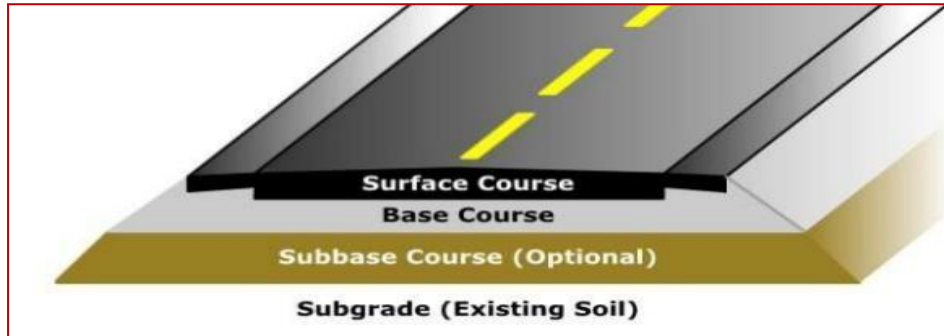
Esquema típico del paquete estructural de un pavimento flexible
